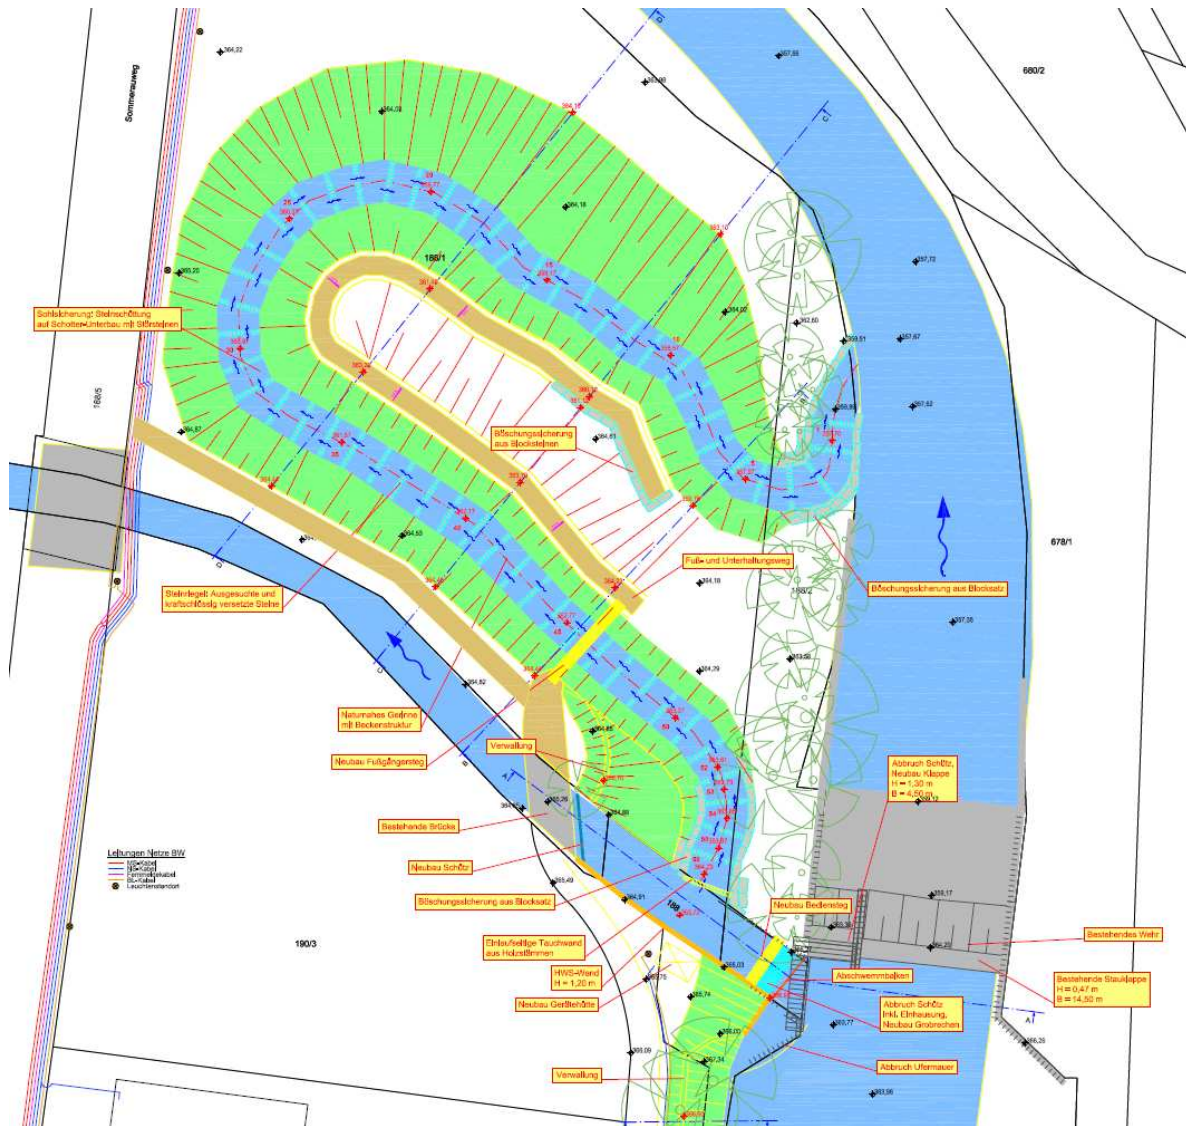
Ausschnitt des Lageplans der Entwurfsplanung des Wehrrumbaus (Wald + Corbe 2017)
